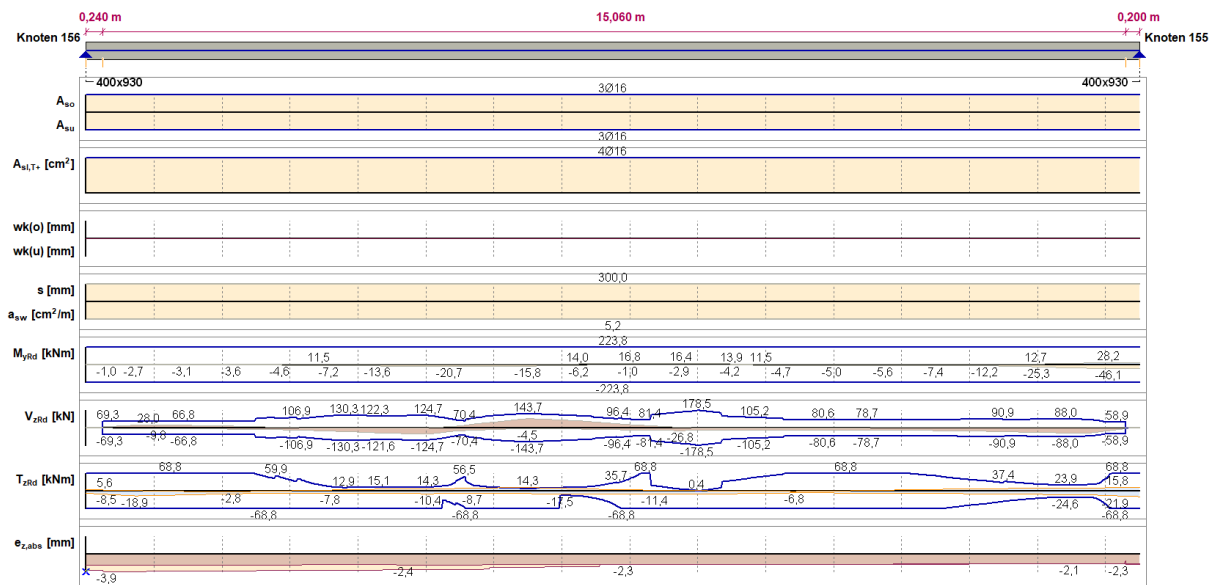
Berechnete Balkenbewehrung Querschnitt 400x930 (Achse 1)
